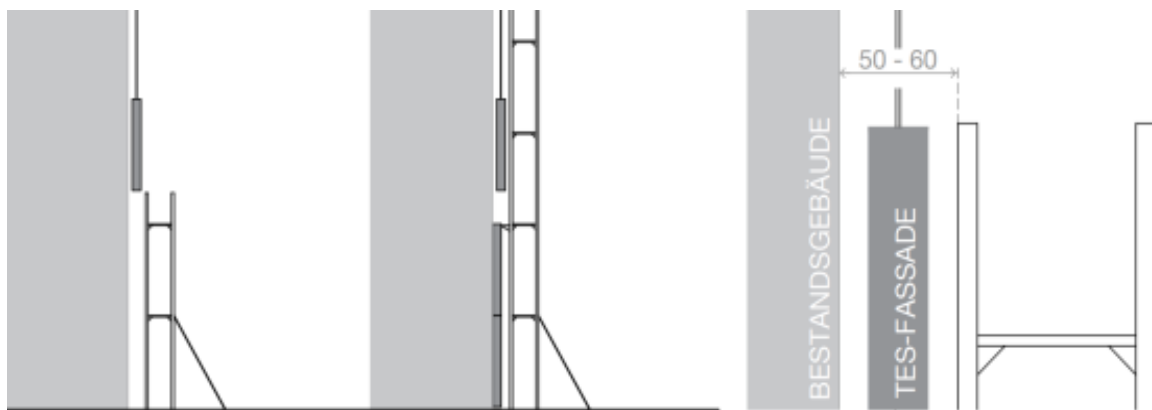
Montage der TES Elemente – das Gerüst wächst mit dem Baufortschritt mit
